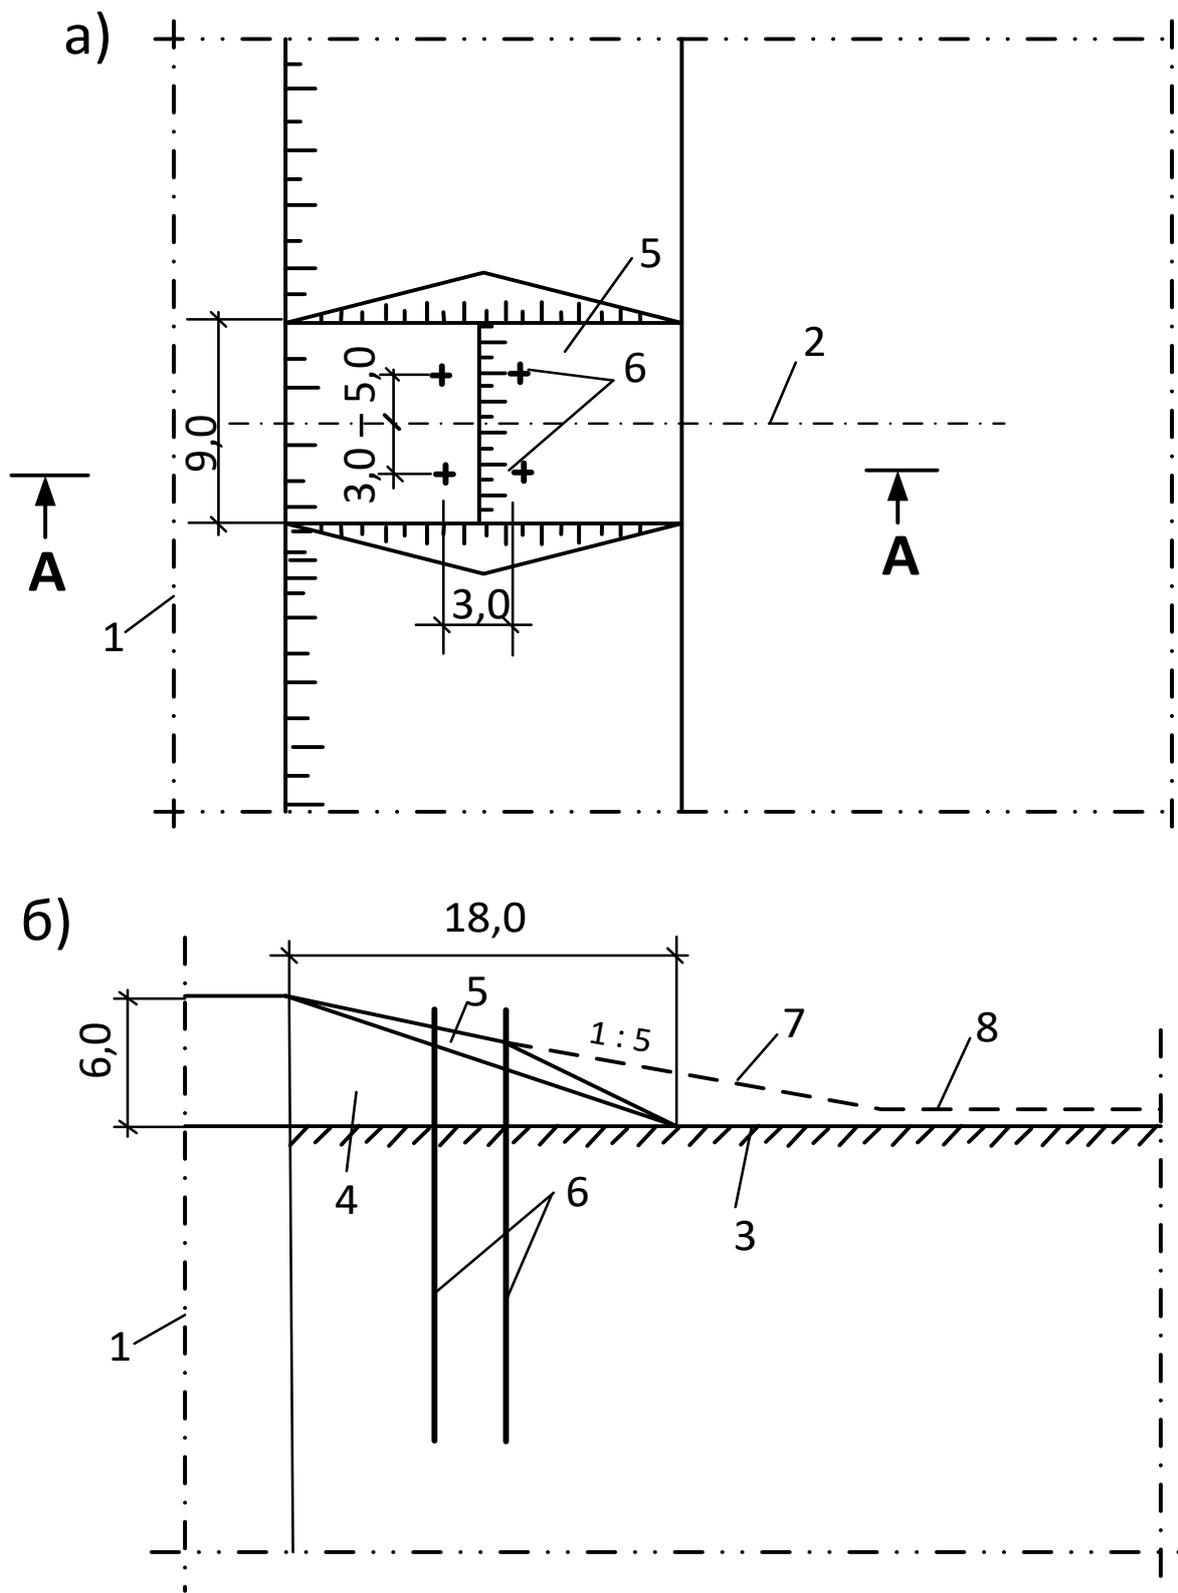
Откосная охлаждающая площадка в зоне водопропускной трубы:
